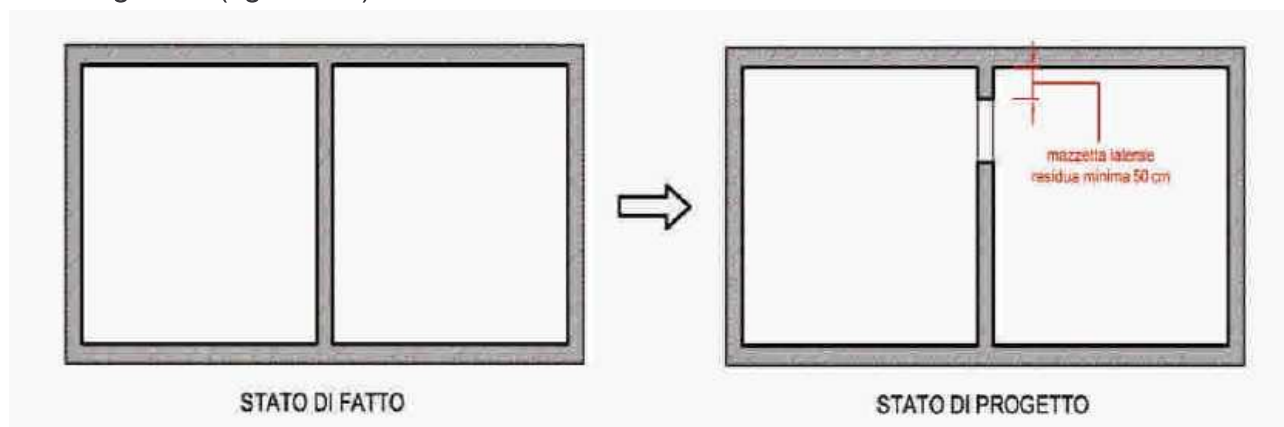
Esempio di mazzetta laterale residua minima da garantire
